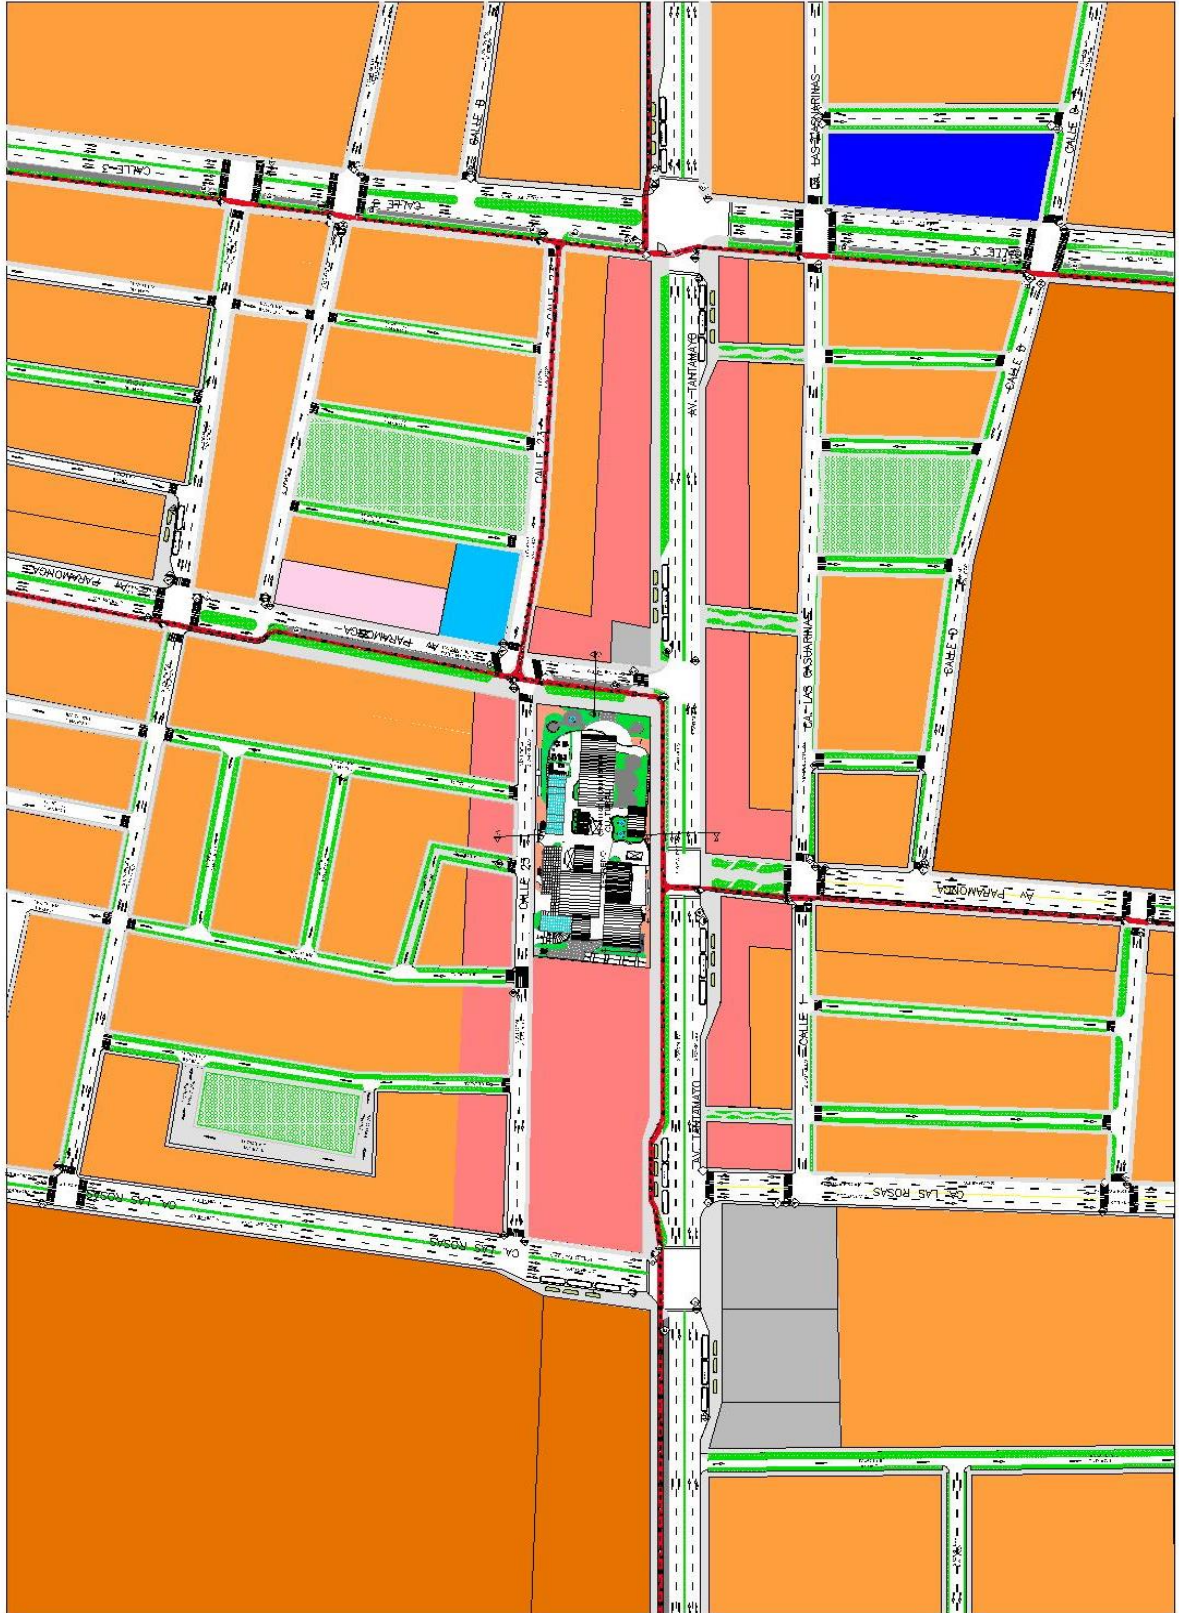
Master Plan del sistema Vial. Fuente: elaboración propia.
